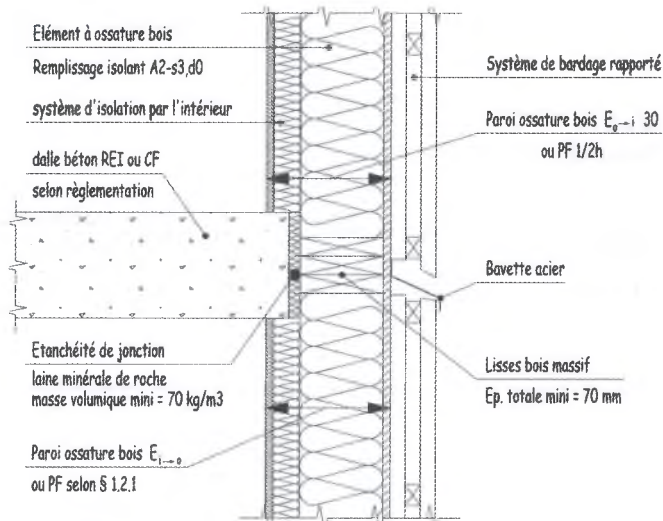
jonction de murs à ossature bois en nez de dalle béton
